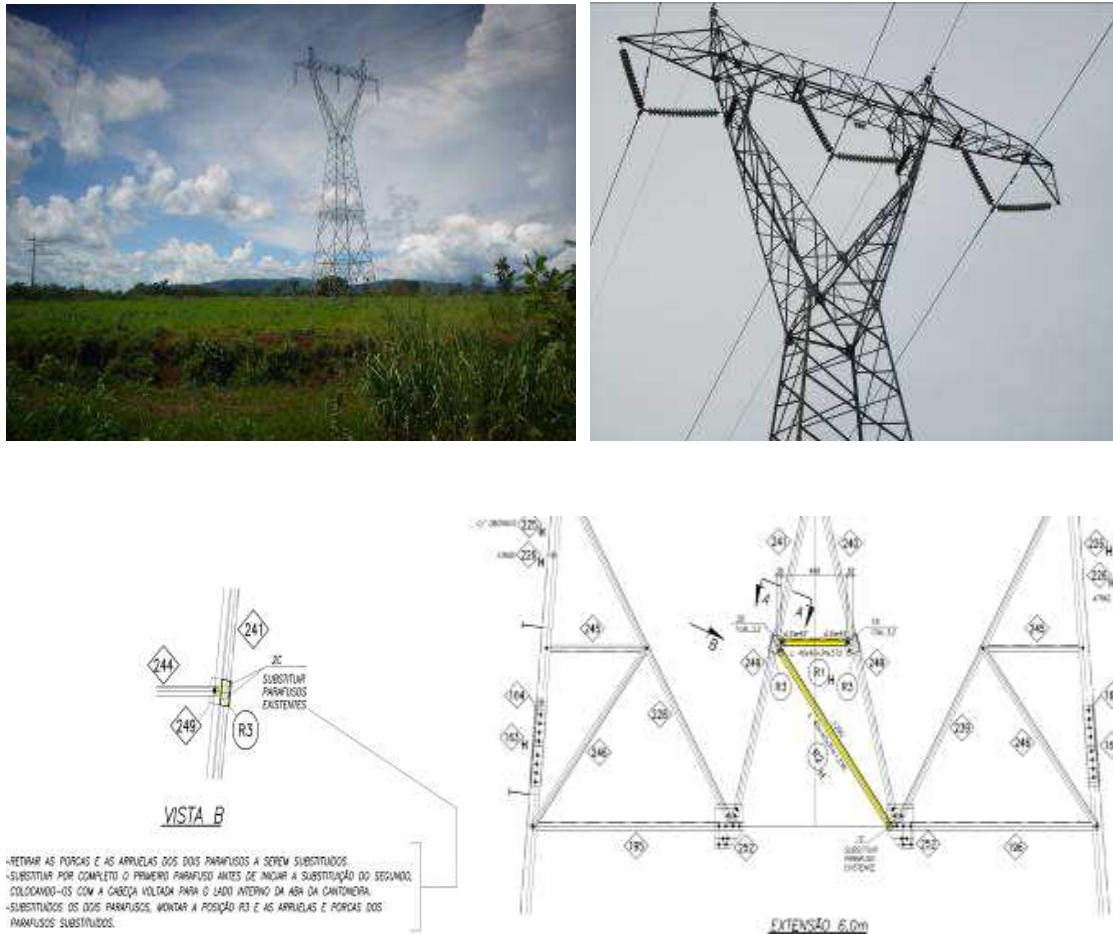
Estruturas S21 e S23 e reforços estruturais introduzidos
